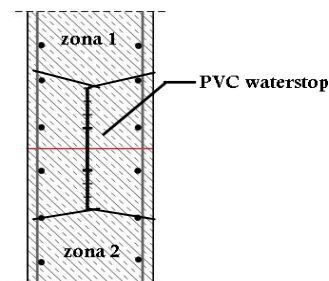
Potongan Sambungan Pelat Lantai Basement
